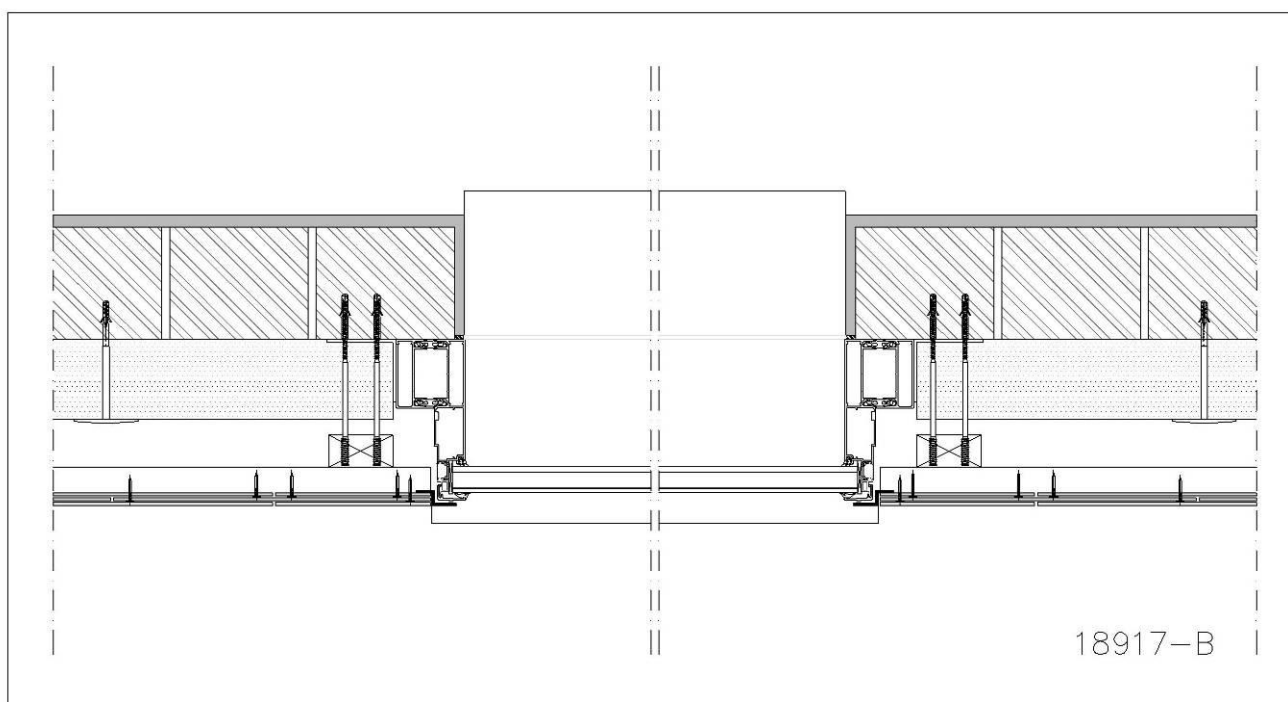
Exemple d'une finition avec fenêtre dans le même plan de la façade – coupe horizontale
